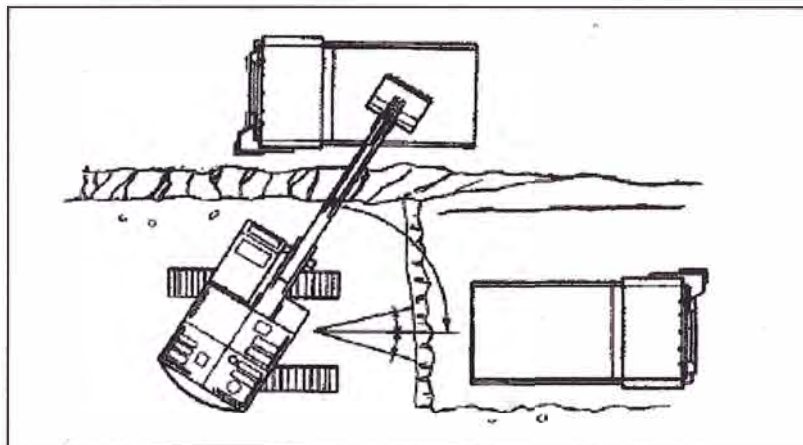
Zona de Trabajo para la excavadora en carguío
